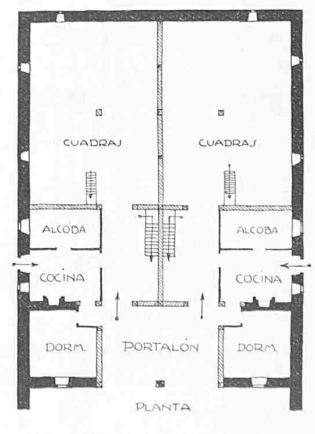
Typischer Grundriss des Bauernhauses von Biscaya.
